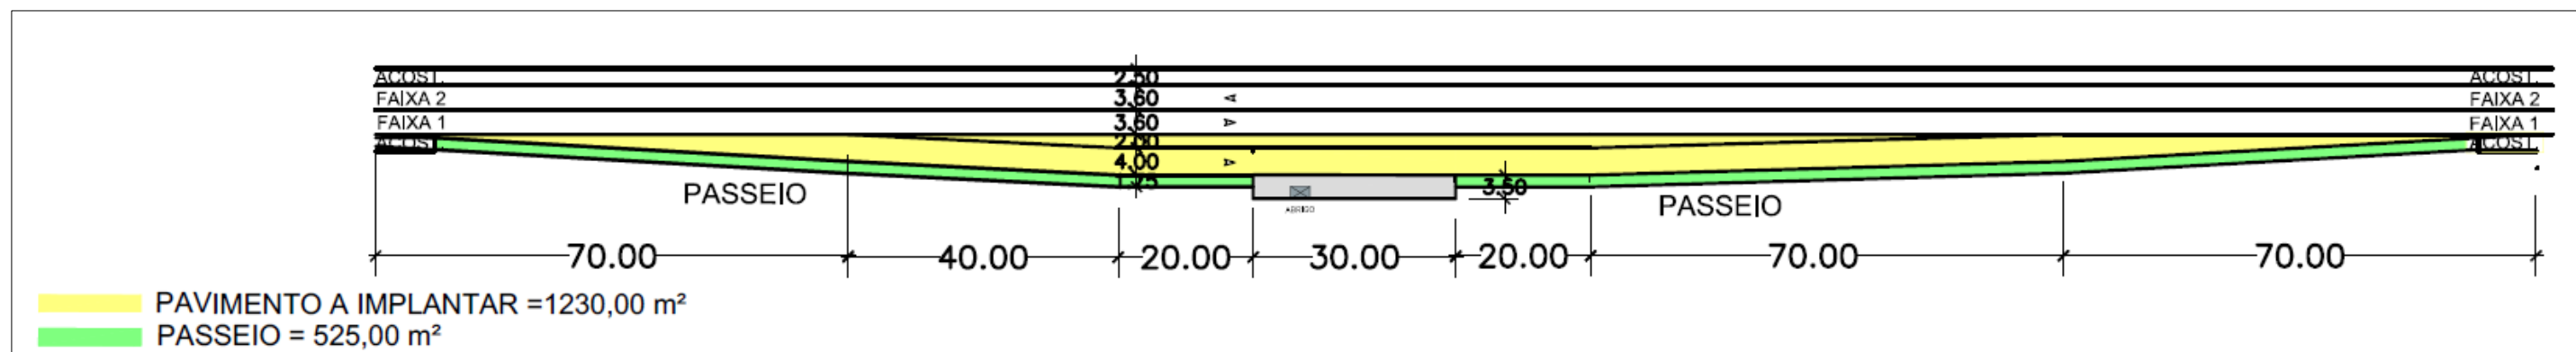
Planta Projeto Geométrico/Pavimentação do Ponto de Ônibus Tipo 1
